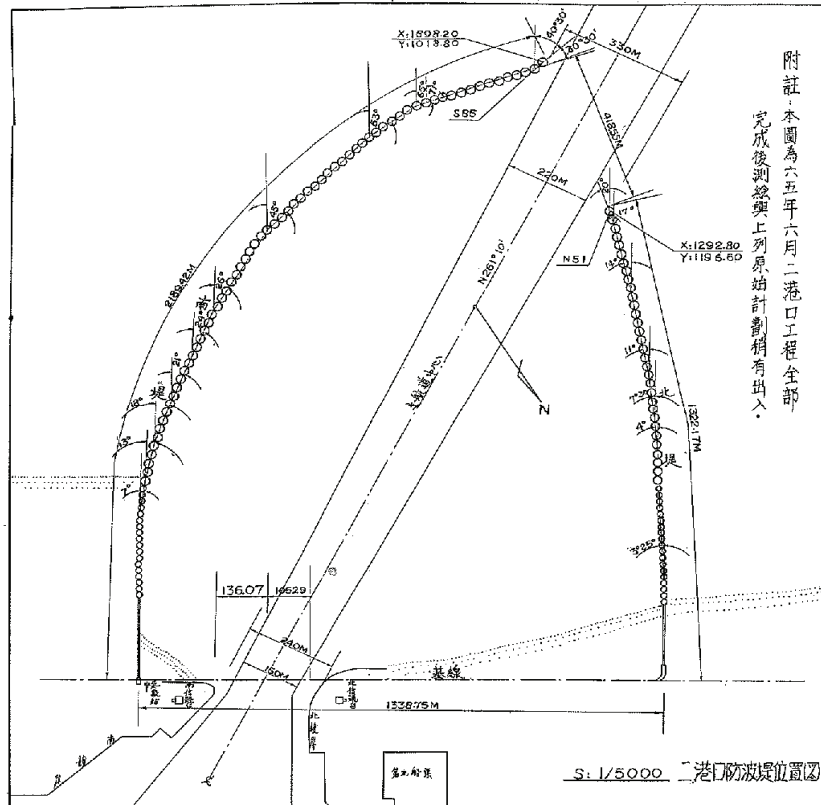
高雄港第二港口防波堤平面配置示意圖
